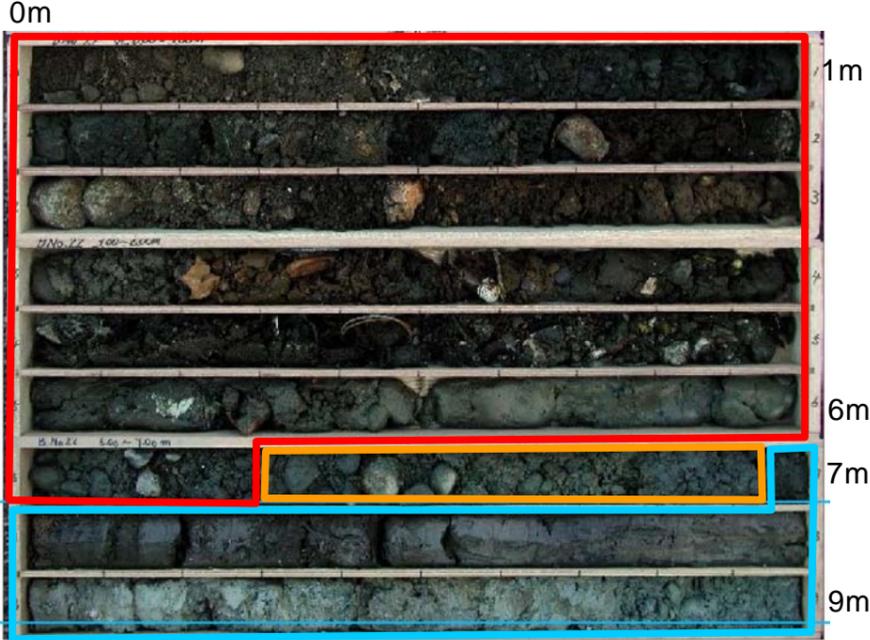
BNo. 22 孔（旧砂利採跡地）
